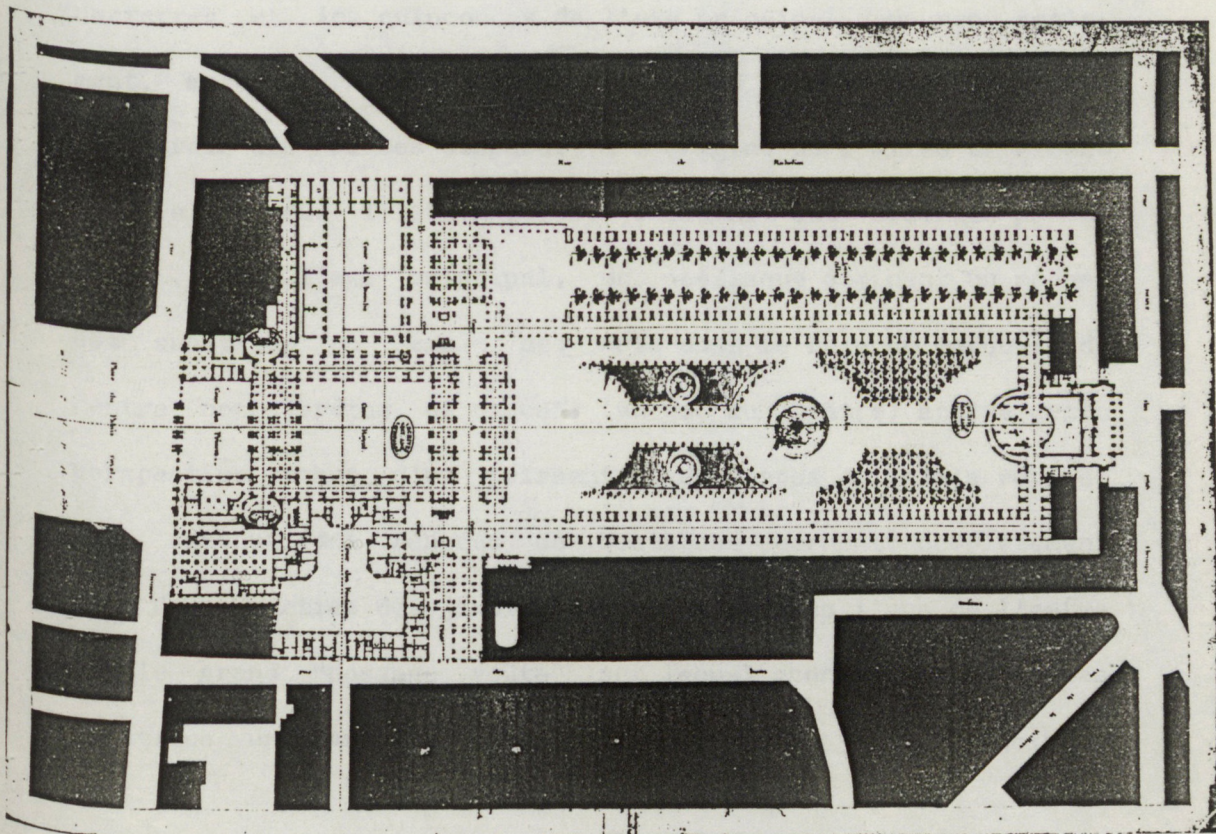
Plan au rez-de-chaussée des augmentations à faire au Palais-Royal, A.N. R4 281
